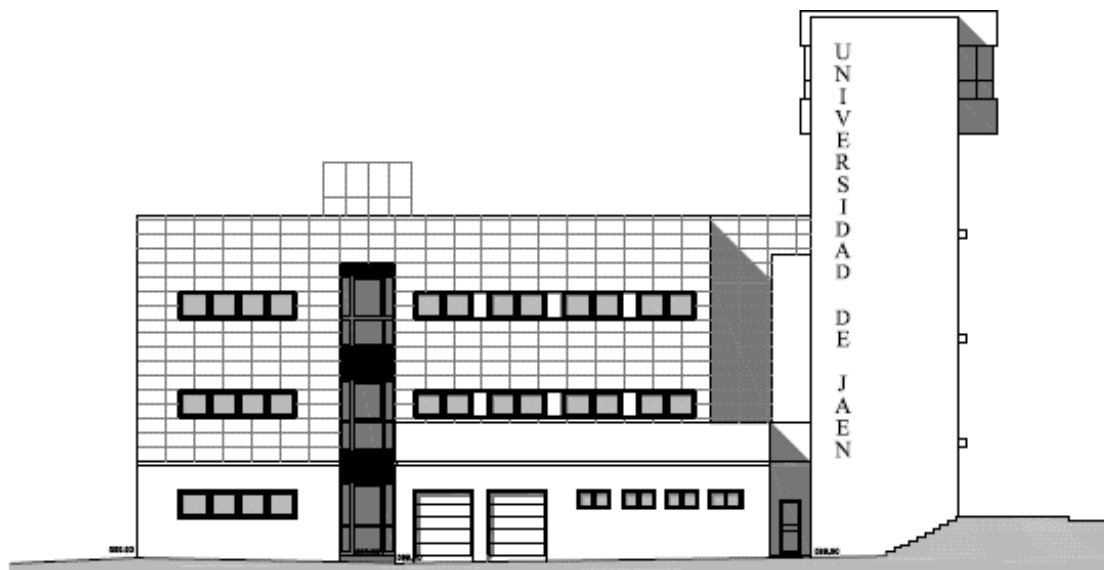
Alzado principal. Fuente: Proyecto técnico de ejecución.
